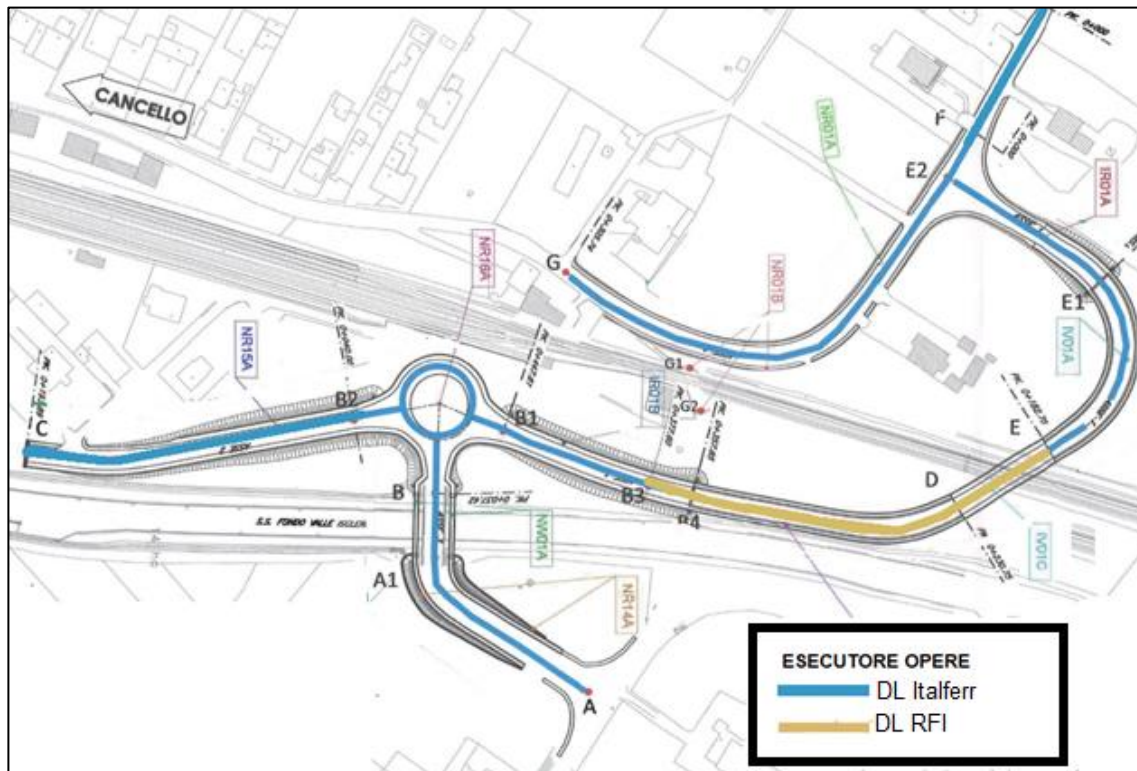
STRALCIO PLANIMETRIA CON INDICAZIONE ESECUTORE OPERE
